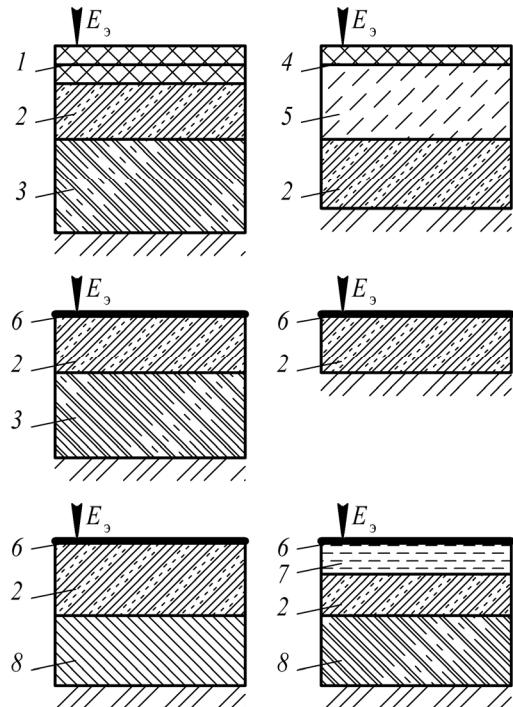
Конструкции оснований нежестких дорожных одежд с применением грунта, укрепленного цементом:
